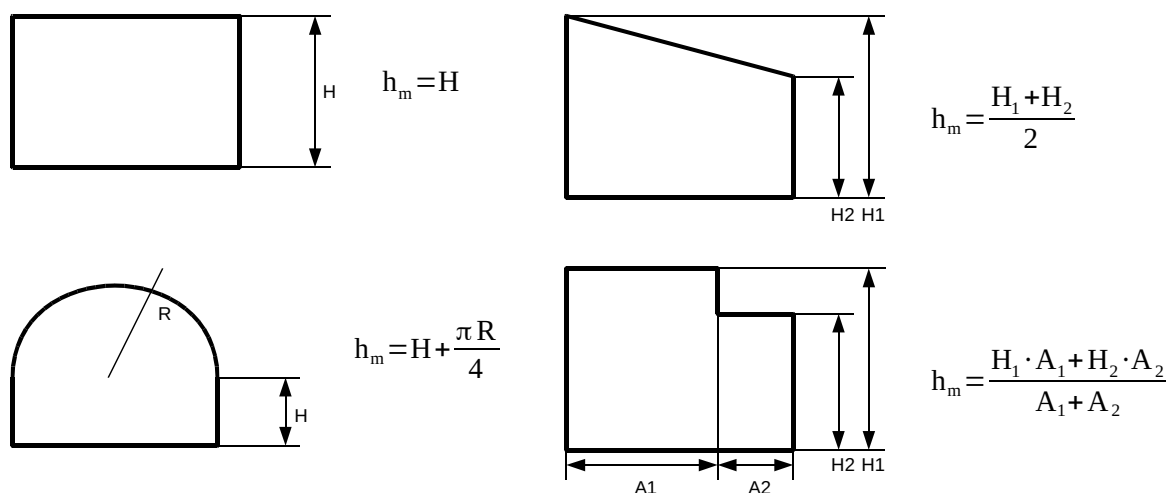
Esempi di determinazione dell'altezza media, in sezione
